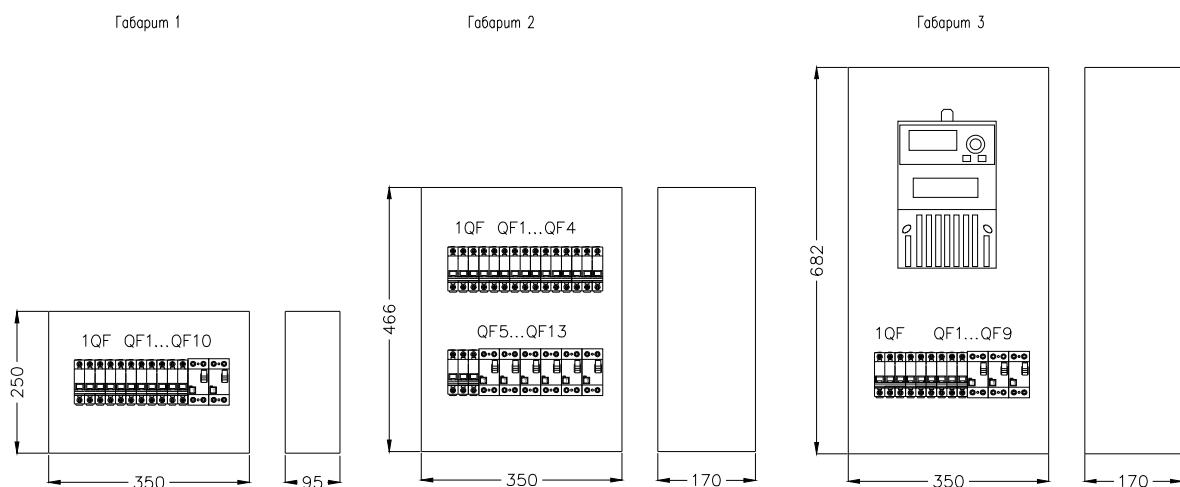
Внешний вид и габаритные размеры шкафа ВРУ8.
